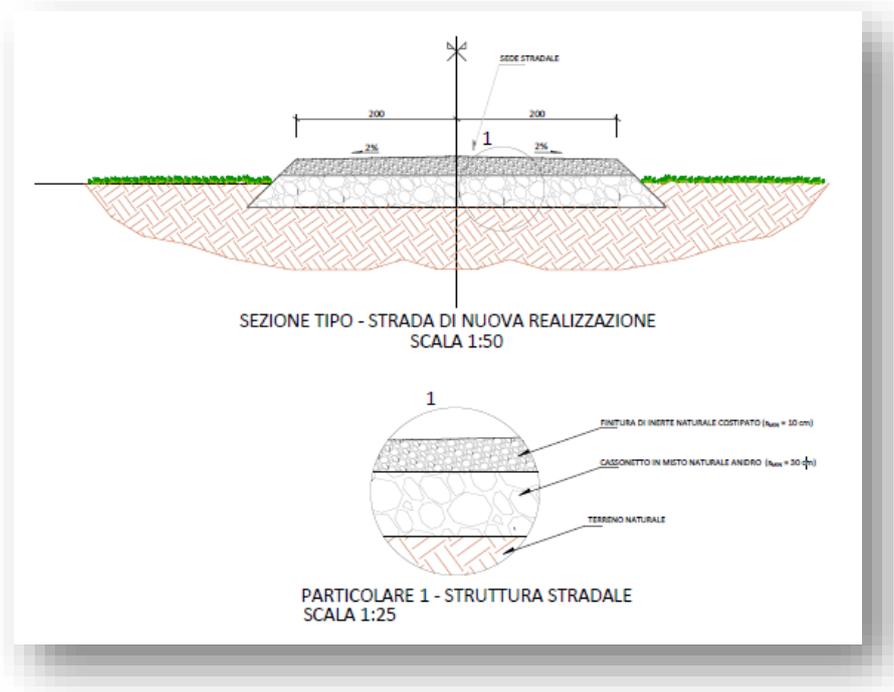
Estratto elaborato 27 (Sezione stradale tipo)
